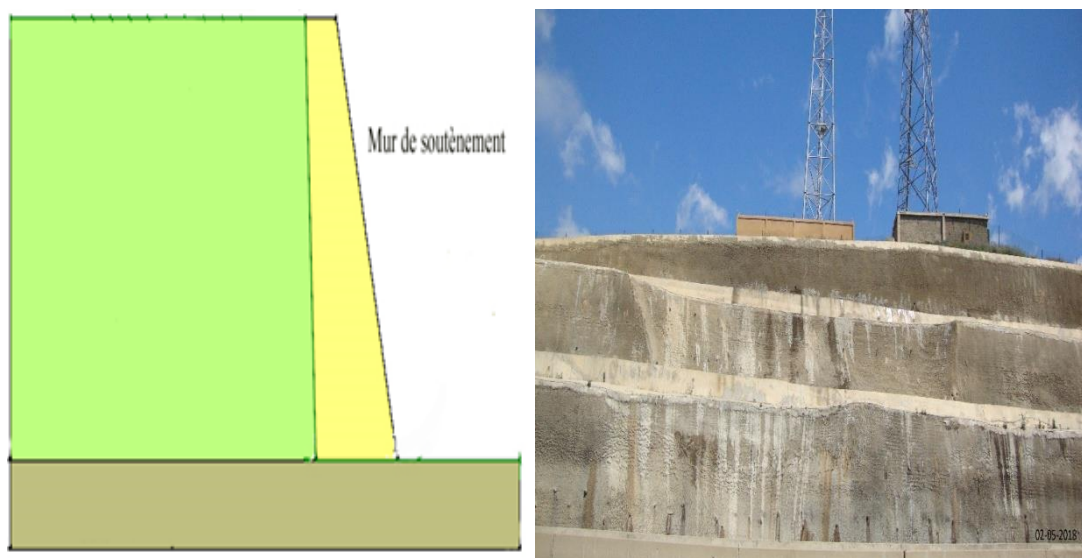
Mur de soutènement en béton armé (Autoroute Est-Ouest).
